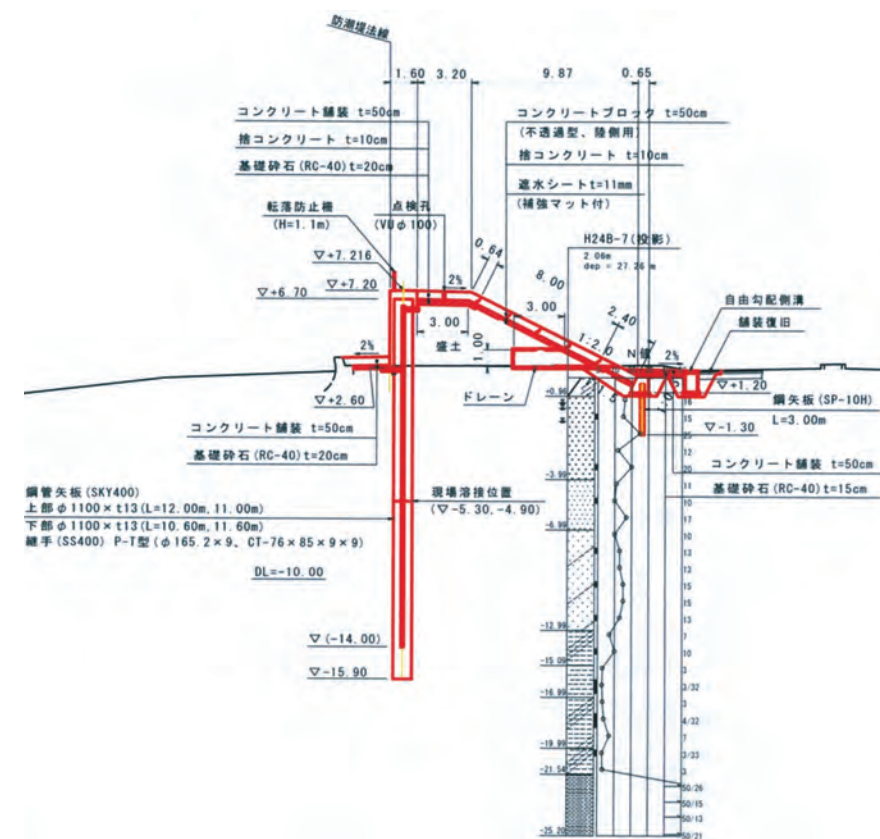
石巻港東浜海岸防潮堤標準断面図
